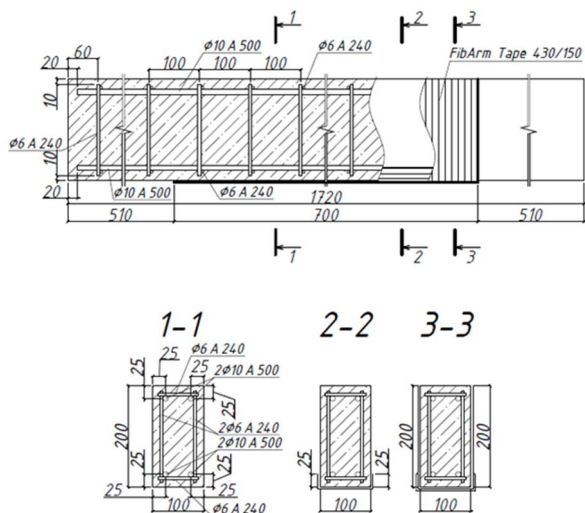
Схема изготовленных железобетонных балок серии Б1
